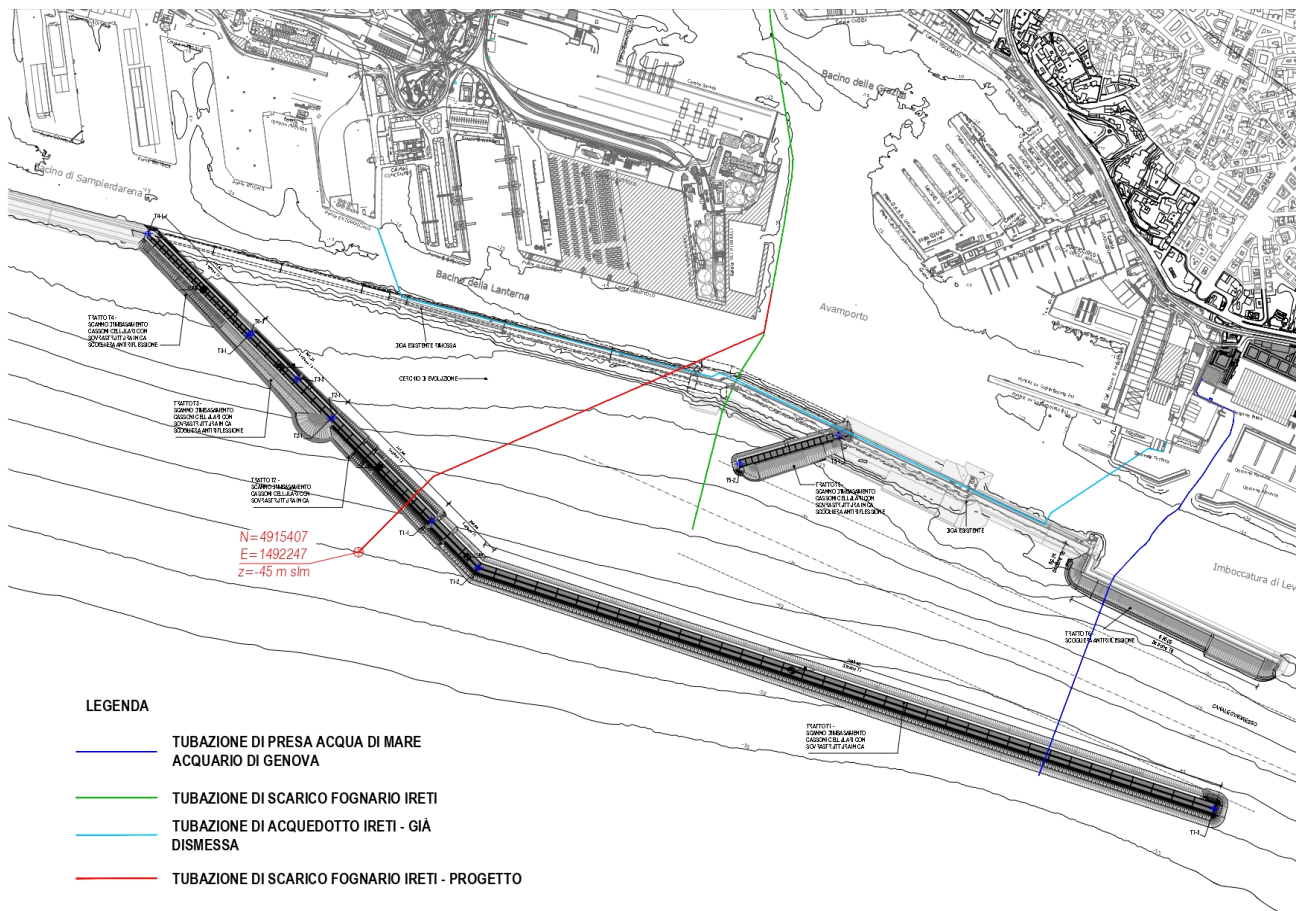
Tracciato planimetrico della condotta di scarico a mare di progetto.
